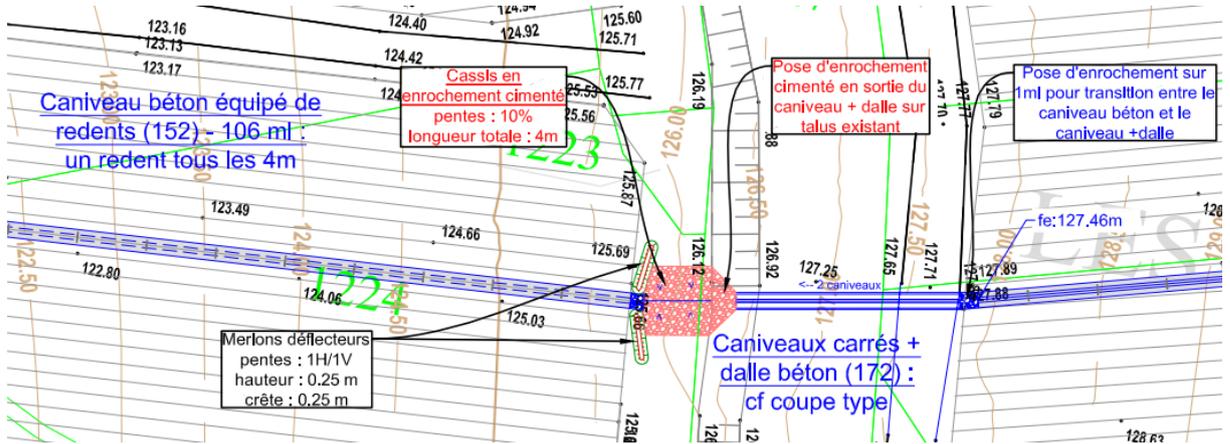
Extrait du plan de masse - Traversée de l'aqueduc n°172
